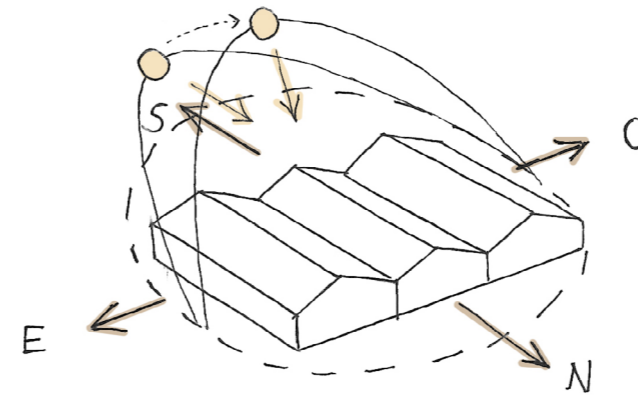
Parámetros de orientación, soleamiento y dirección de viento tenidos en cuenta al plantear posiciones de implantación del prototipo.
